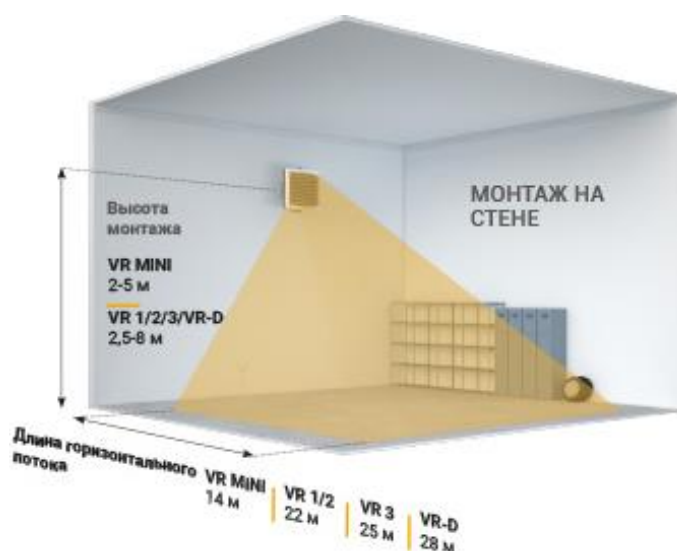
Схема распространения воздушной струи при монтаже на стене
